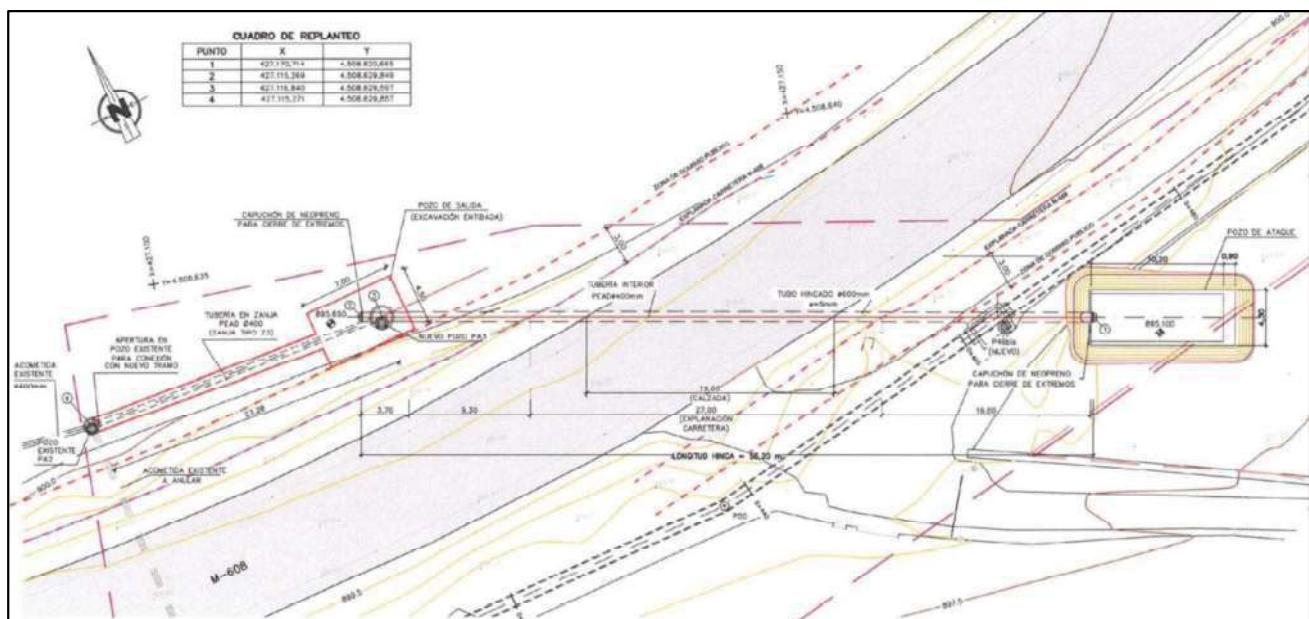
Planta de la hinca bajo la carretera M-608 (tomado del plano 5.3. de Proyecto).
